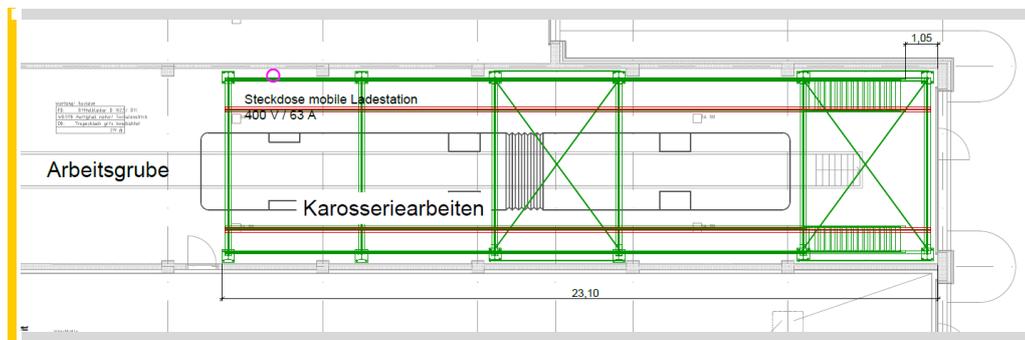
Grundriss DAS Variante 1
